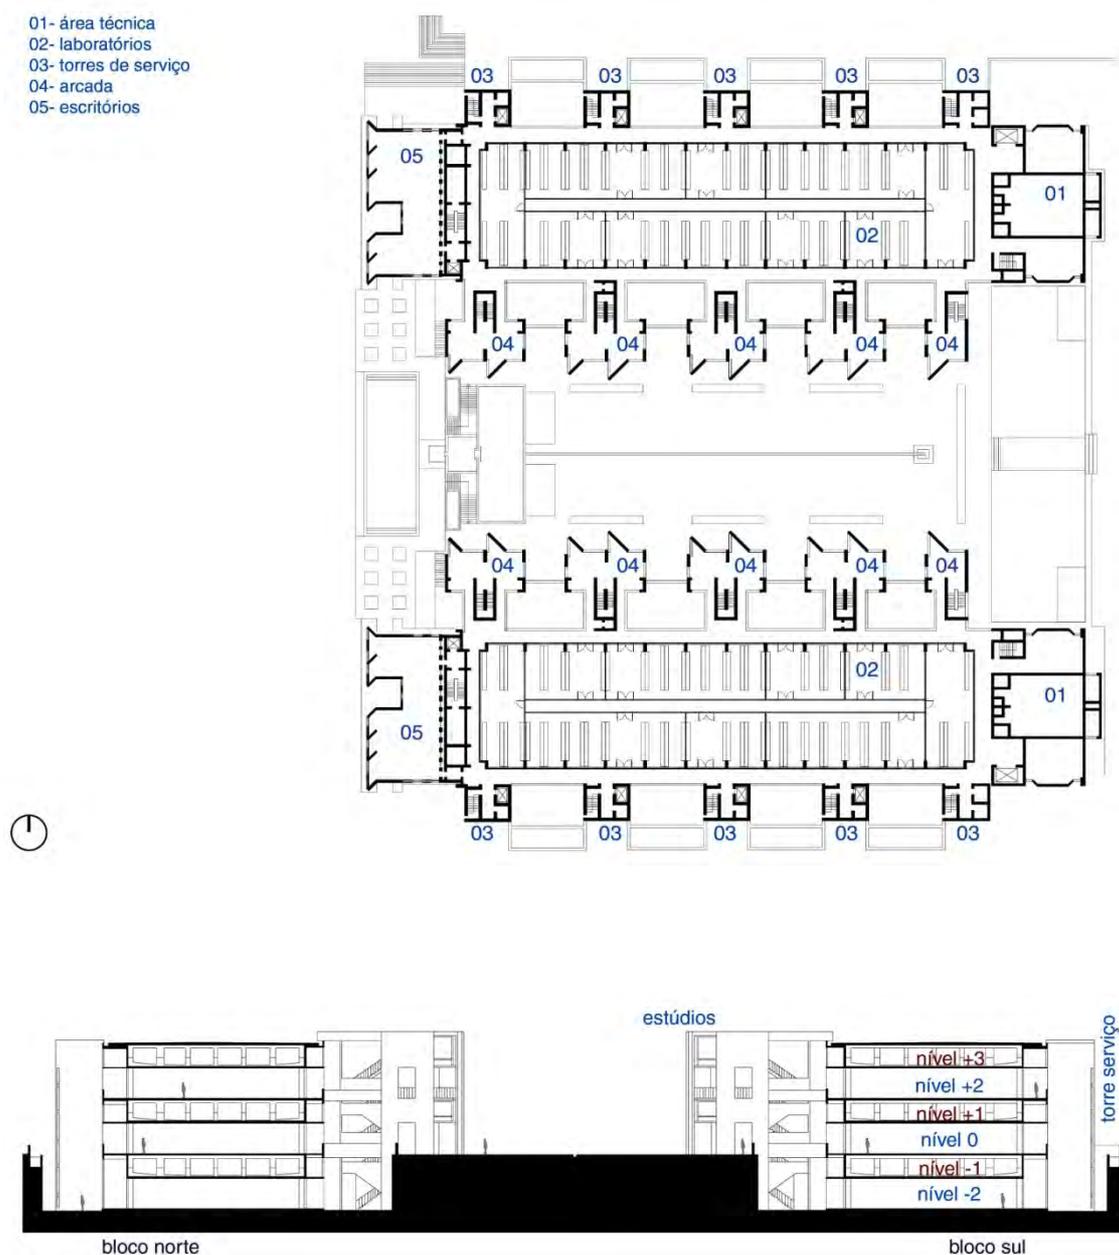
| Planta e corte do Salk Institute [redesenho do autor]
